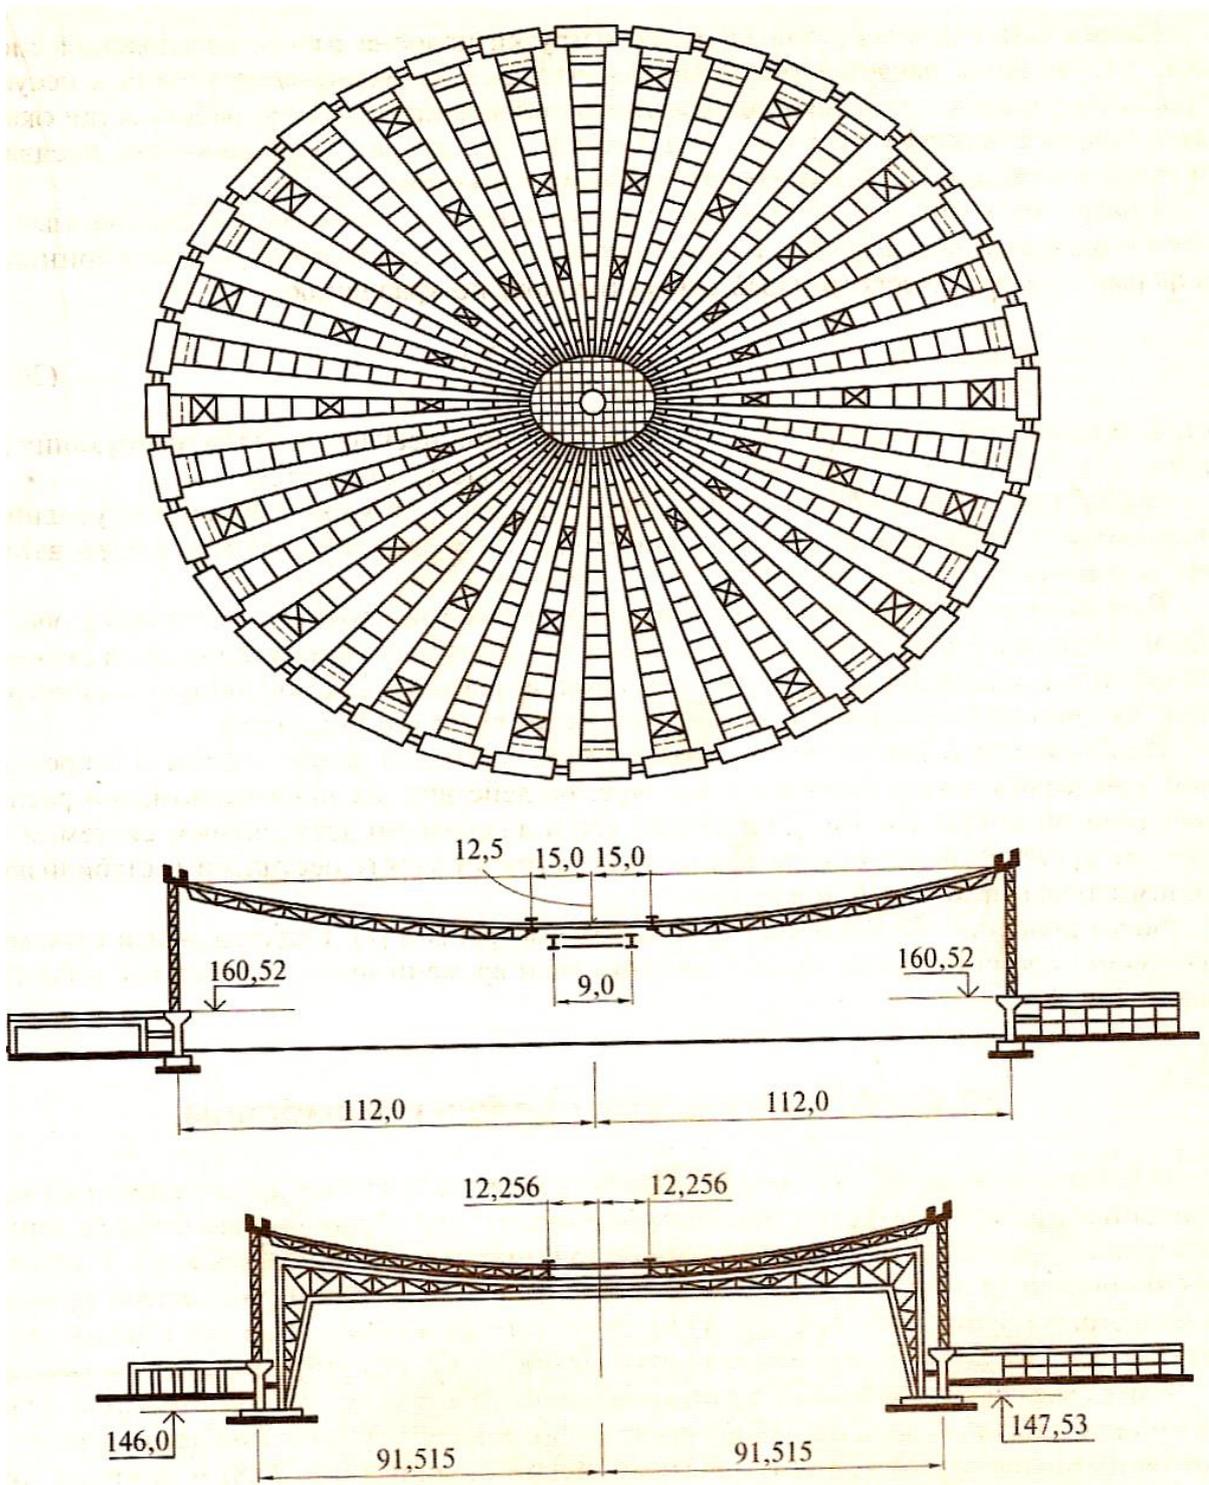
Провисающее мембранное покрытие на овальном плане
